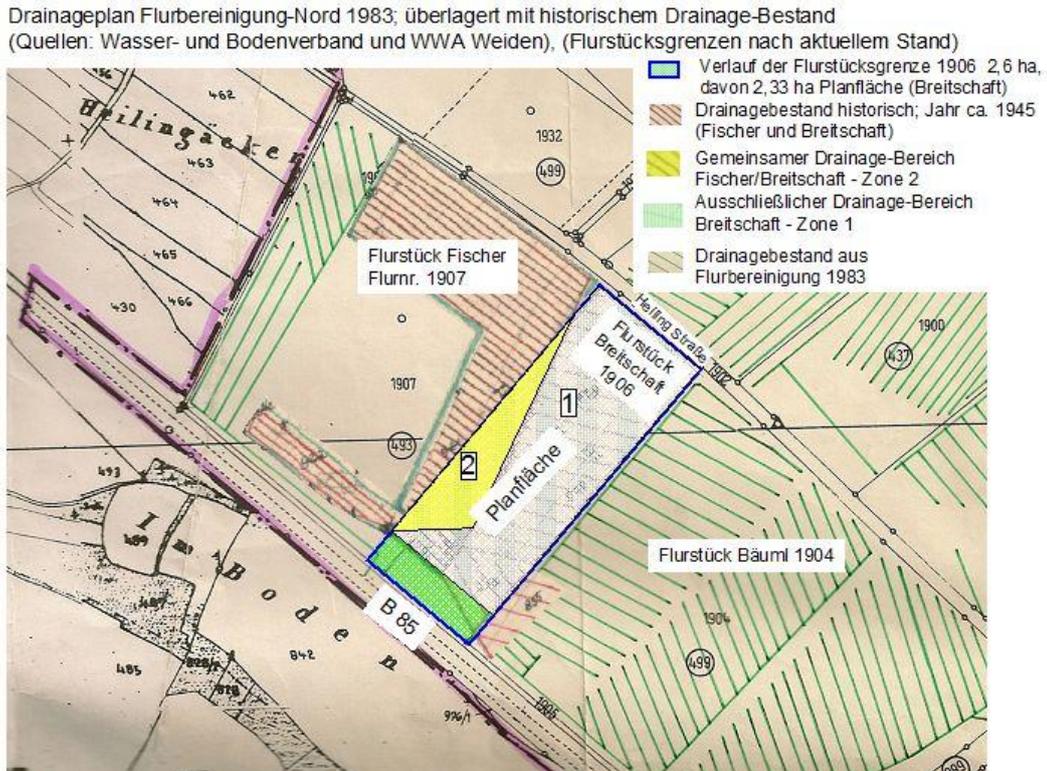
Drainageplan Flurbereinigungsplan mit Erläuterung (unmaßstäblich); an der Westseite der gelb markierten Fläche wird die neue Drainageleitung verlegt.
